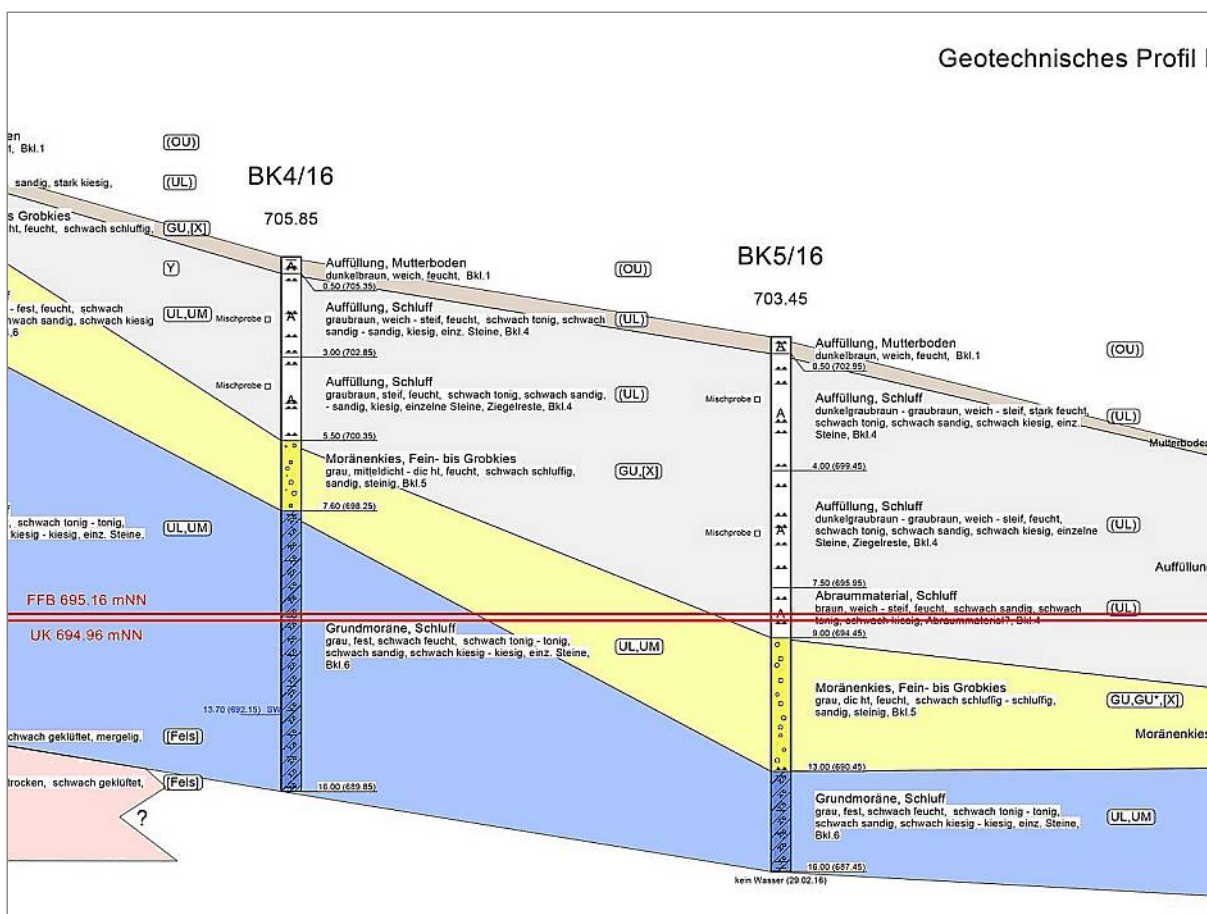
geotechnisches Profil im Bereich des Geländeeinschnitts der Lagerhalle (fm geotechnik)
